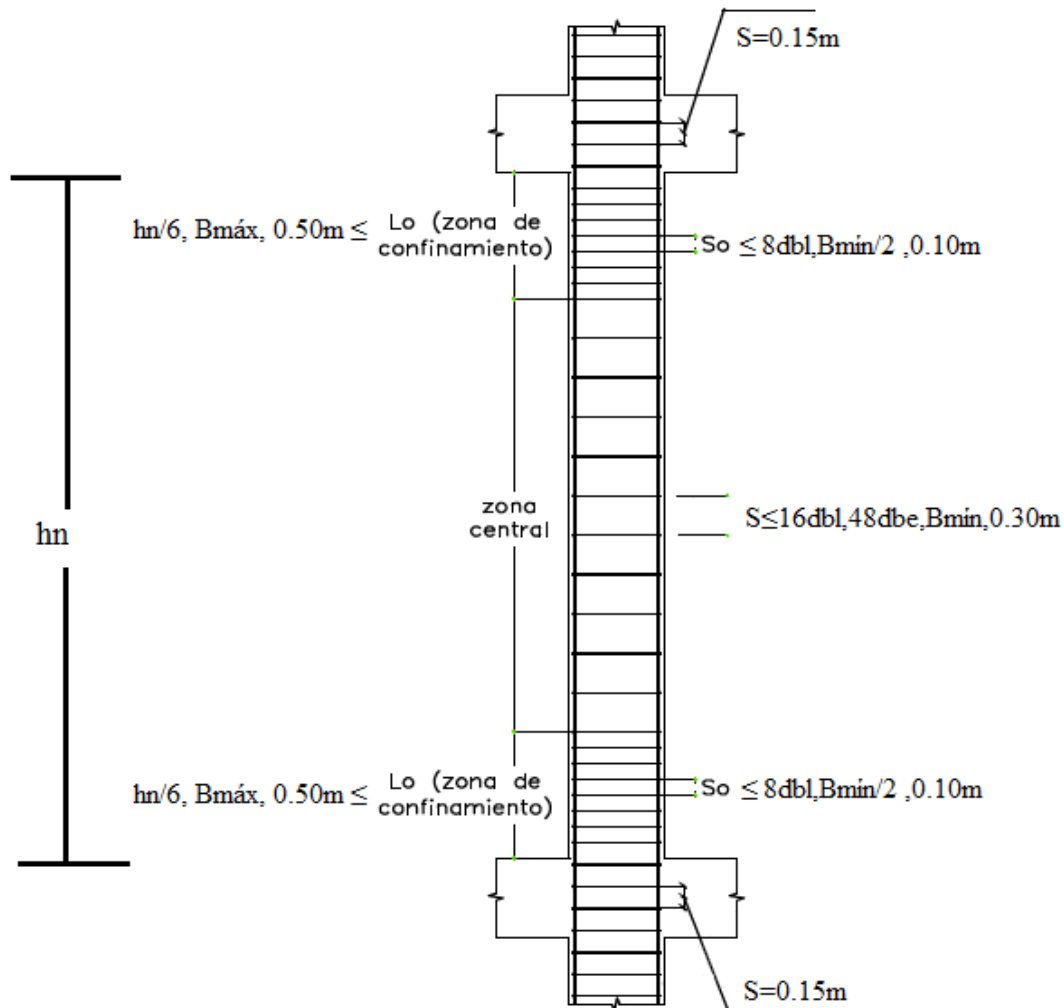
Requerimientos de columna con sistema resistente a fuerzas laterales de muros estructurales
